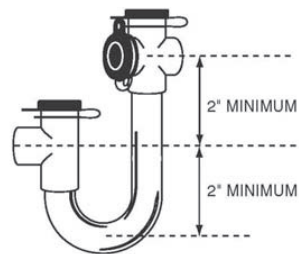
Instalación de tubería de drenado - Vista A/B
